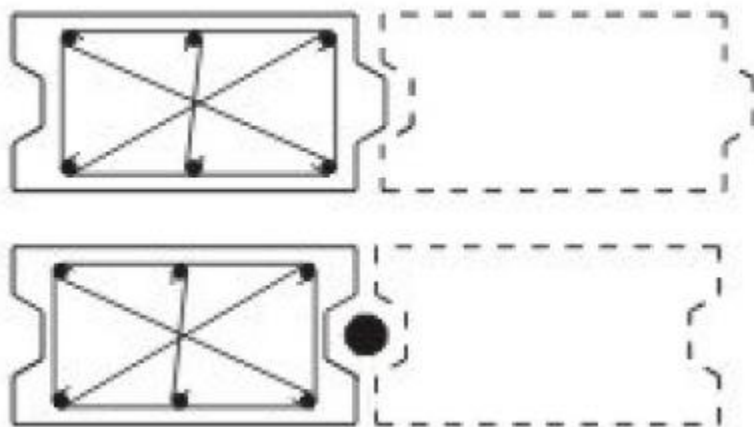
Exemple de palplanse din beton armat sau precomprimat si de tipuri de îmbinari
